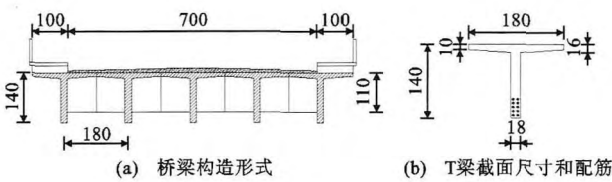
梁桥构造形式、T 梁截面尺寸和配筋(单位:cm)
